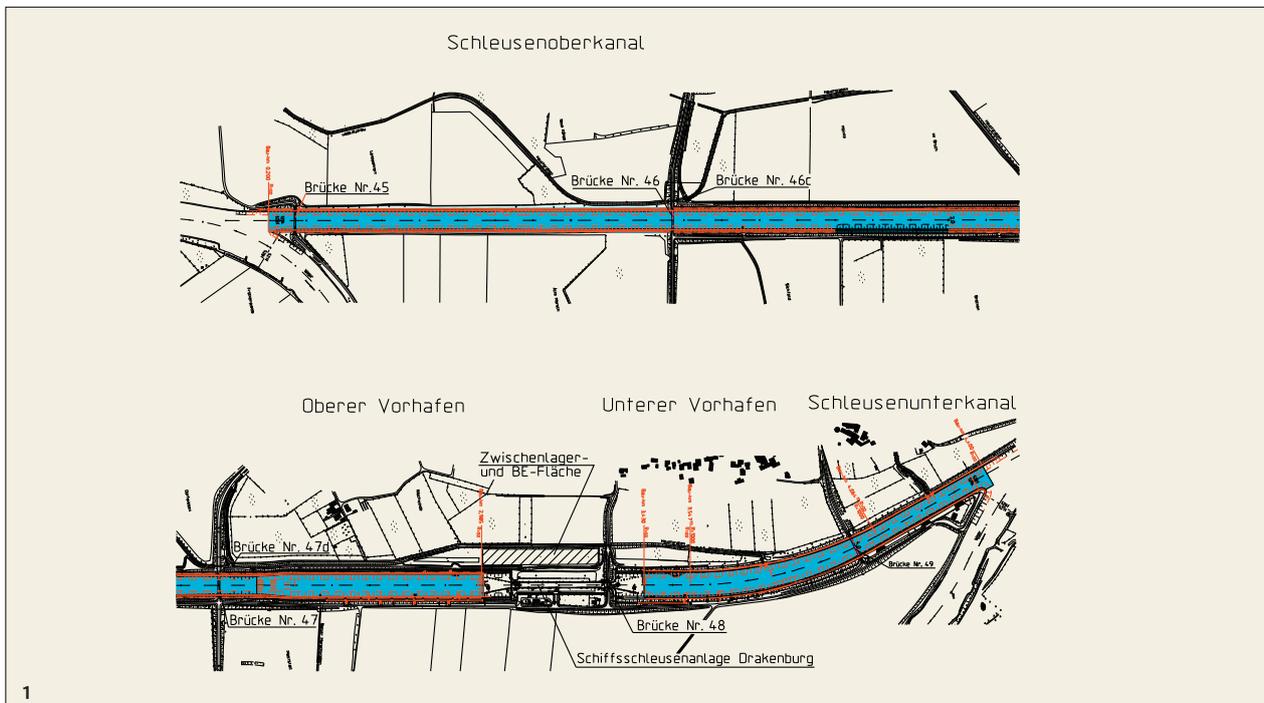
Übersichtslageplan Schleusenkanal Drakenburg
